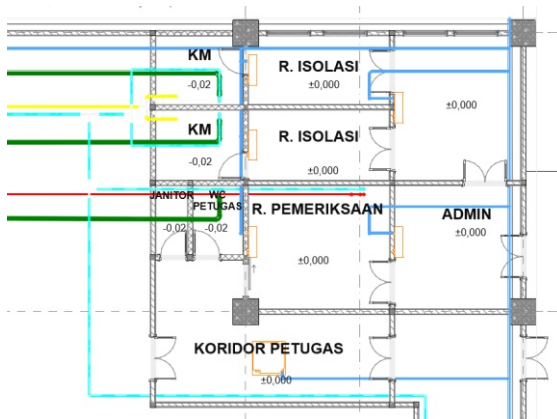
Modeling Elemen utilitas dengan Elemen struktural Parsial Poliklinik
